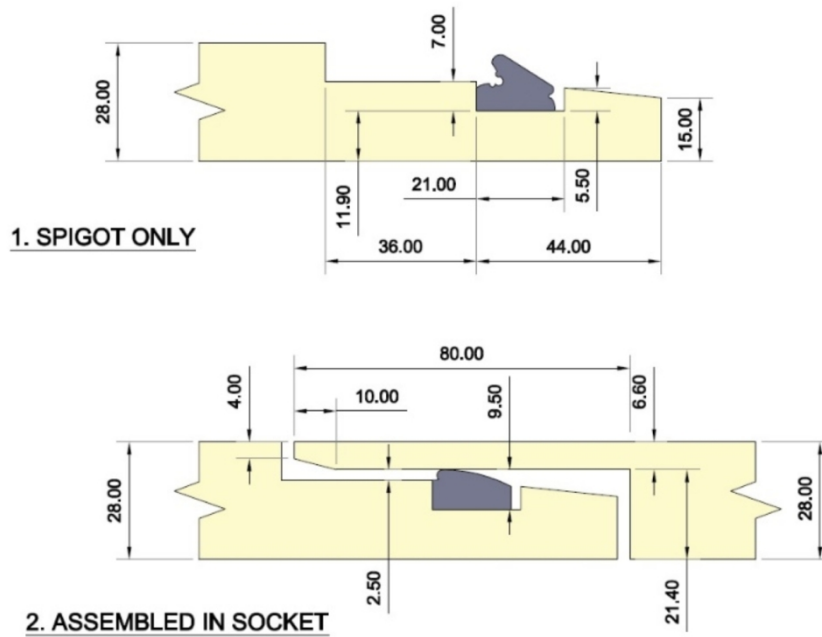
Assemblage de type I – Joint S19 Spigot seal
